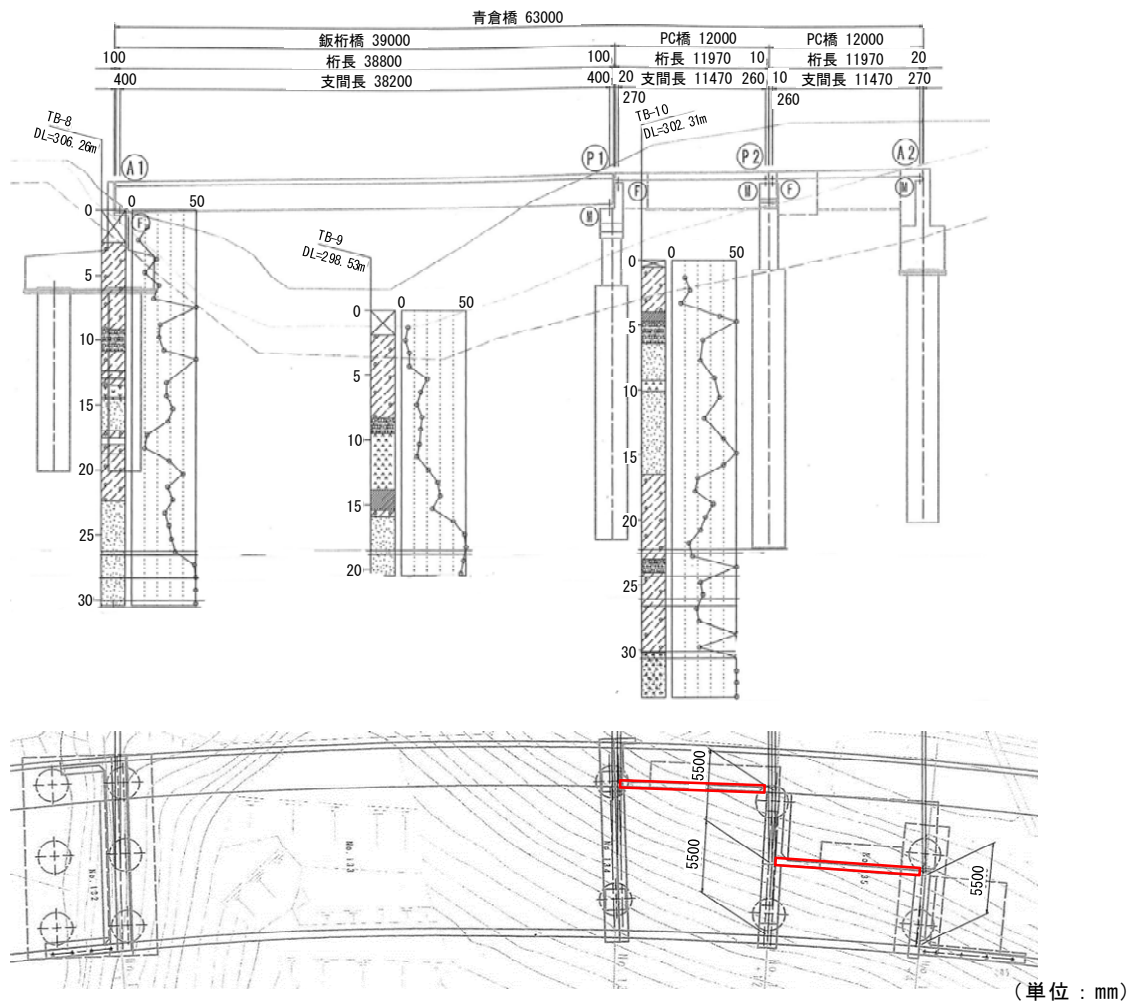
青倉橋(上:側面図, 下:平面図)
